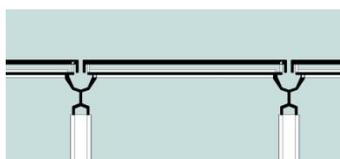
Corte cobertura – painel duplo de argamassa armada com colchão de ar
